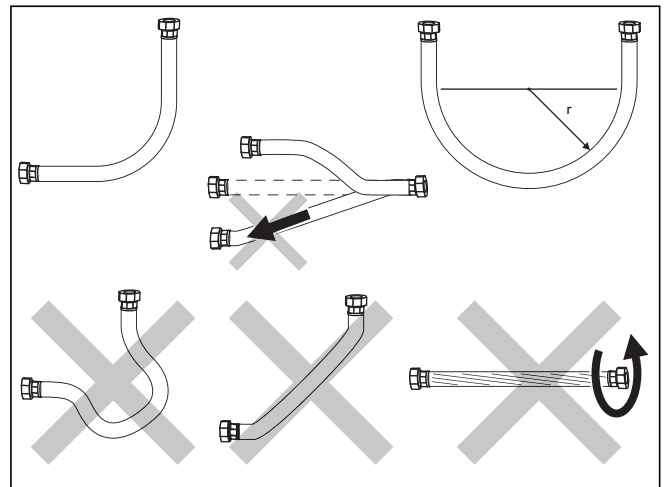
Umgang mit flexiblen Anschlussleitungen
